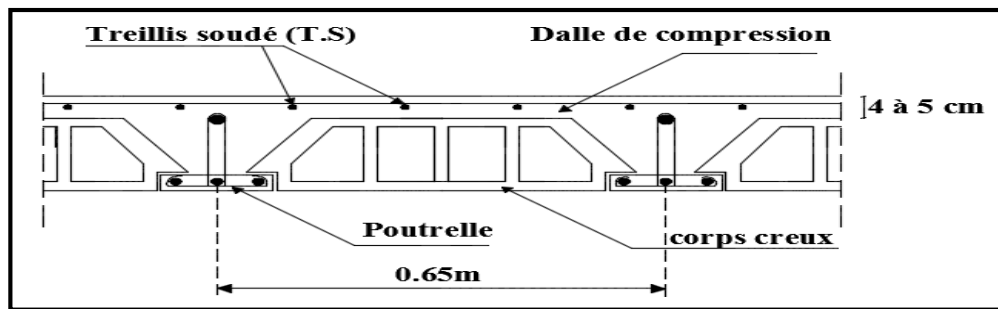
Coupe verticale d'un plancher en corps creux la disposition des poutrelles.
